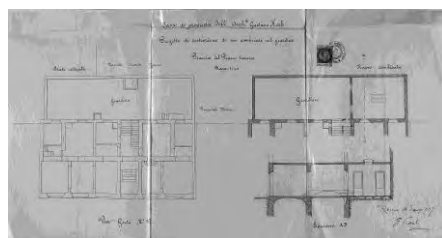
casa di Proprietà Koch ampliamento pianta e sezione
